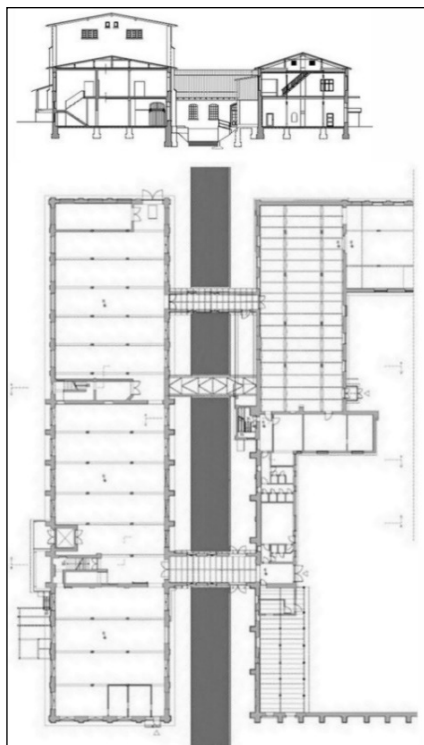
Grundriss EG und Schnitt Fabrikhallen ADC mit überbrücktem Petersbach (Quelle: Bauaufnahme Hochschule Zittau/Görlitz 2004)
